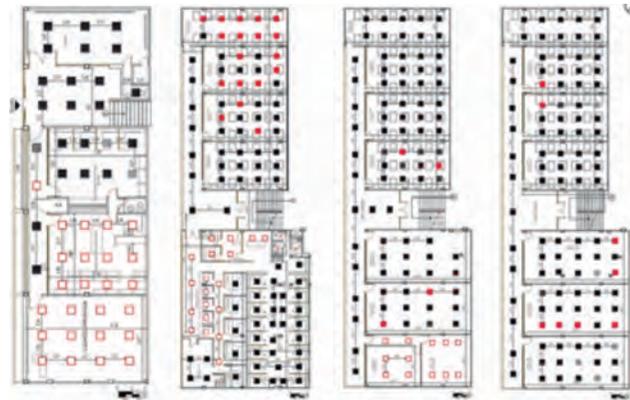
Plantas del bloque A (Levantamiento planimétrico)
